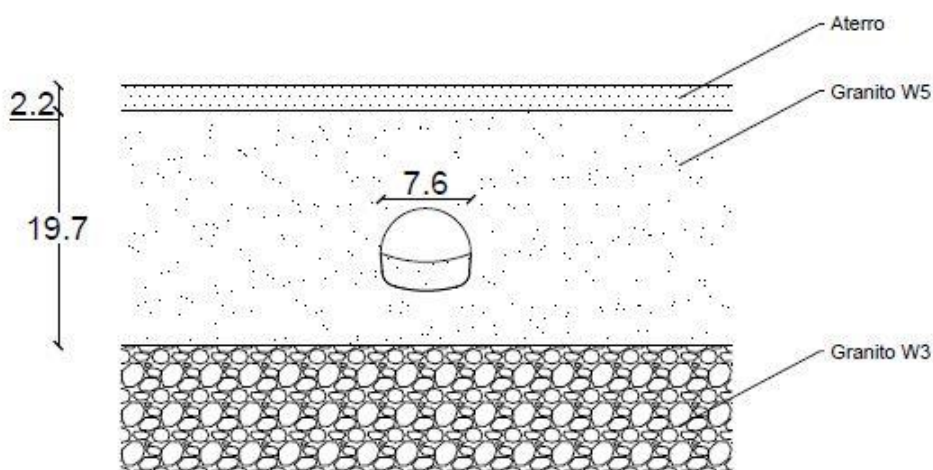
Perfil geotécnico e secção transversal do túnel
